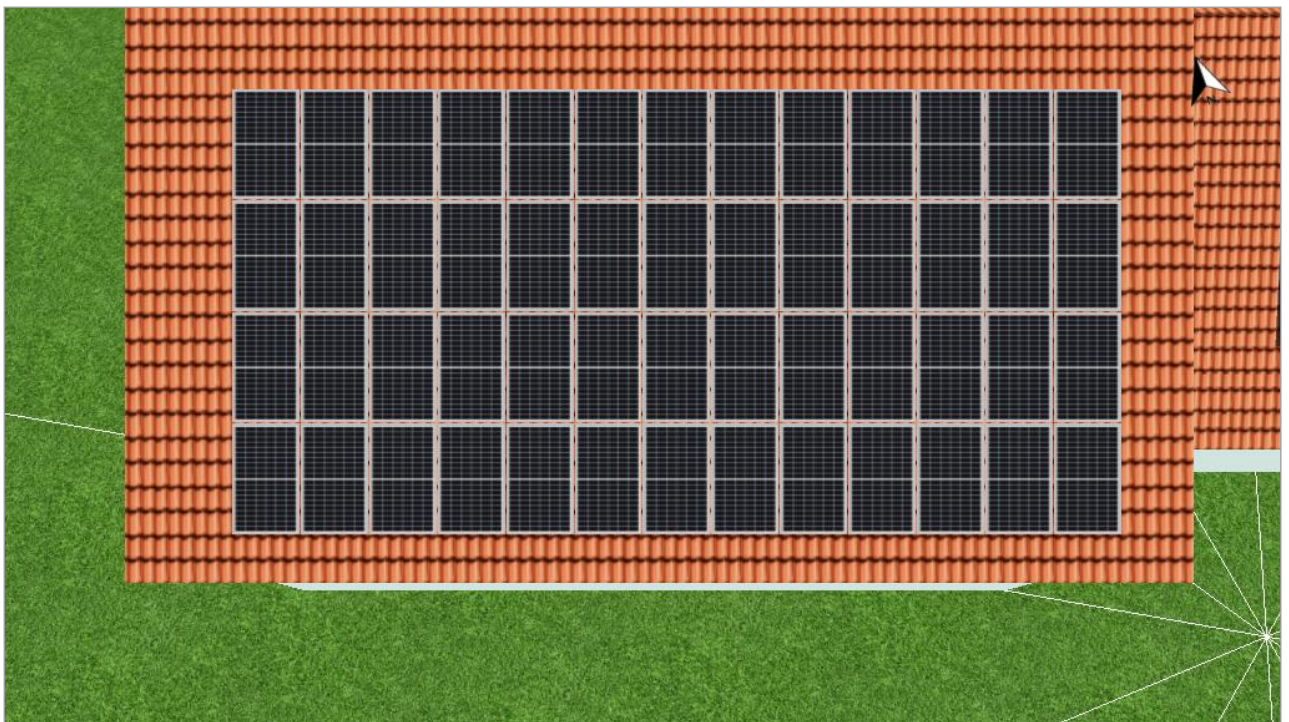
Modulfläche - Gebäude 01-Dachfläche Süd
